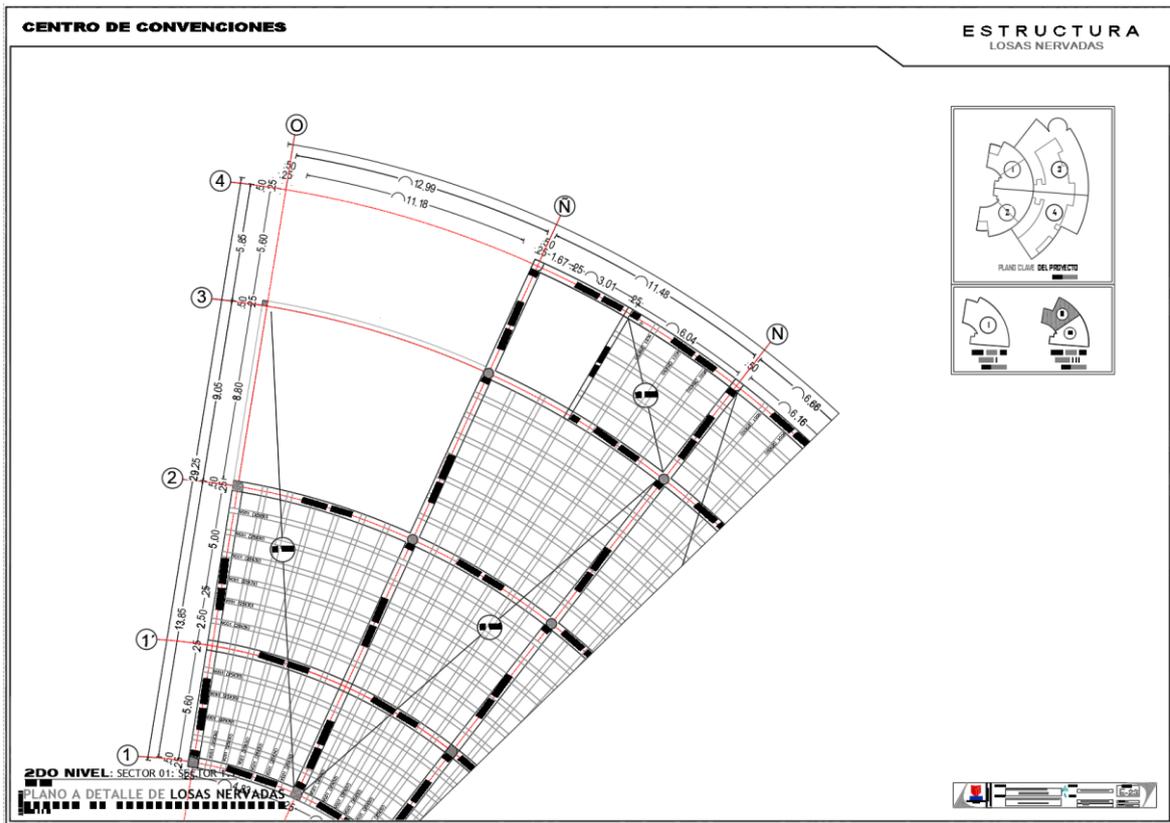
Plano a detalle de losa nervada del segundo nivel: sector 01: sector 1.2.
